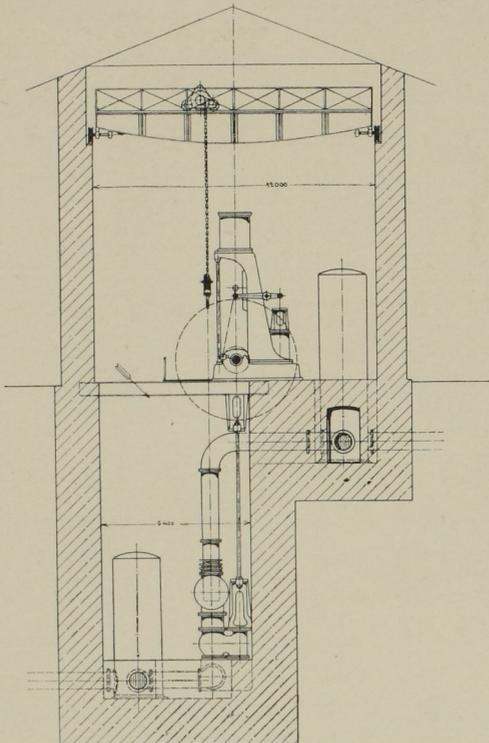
Pumpwerk mit Zubringepumpen. Massst. 1:300.
